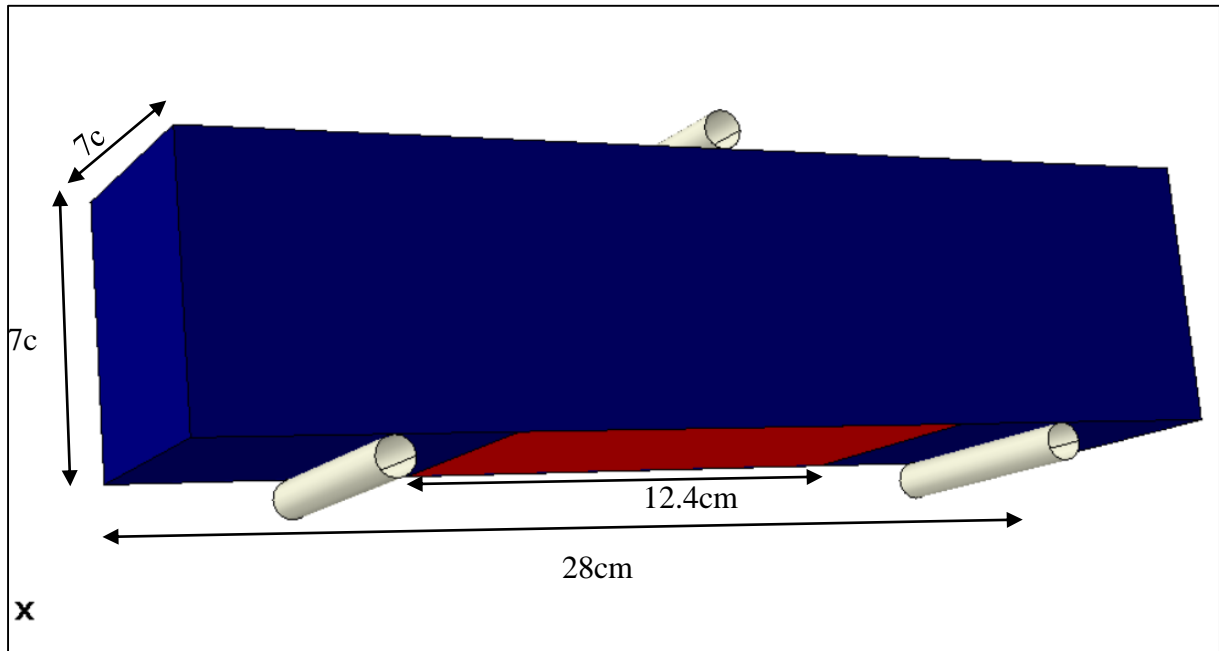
Mode de chargement de la Poutre renforcée par
